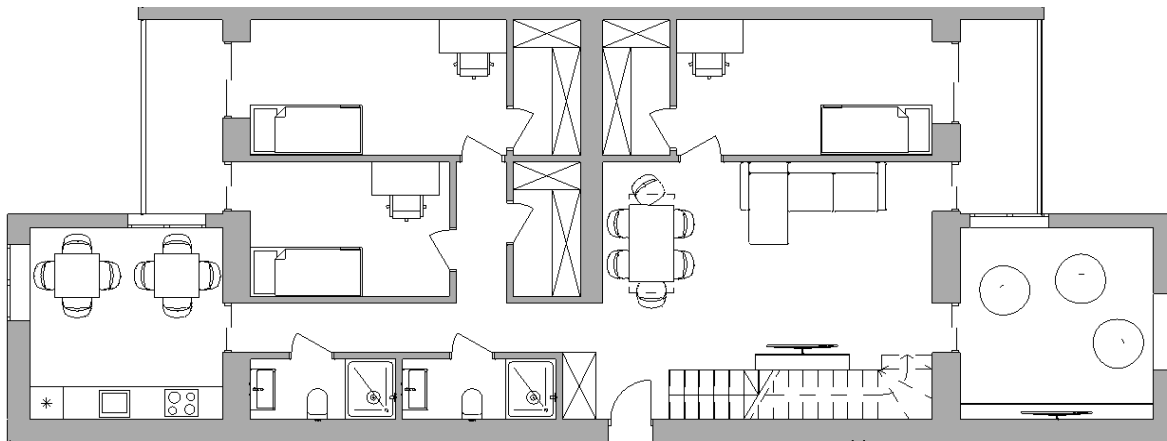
План 1 поверху дворівневого коворкінгу (6 поверх будівлі)
